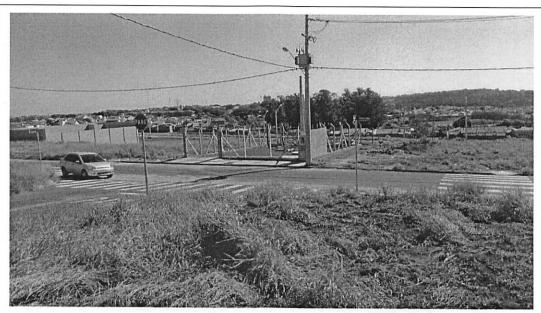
Vista de outro ângulo da área direta de onde será instalado o empreendimento do site GDWSP.
